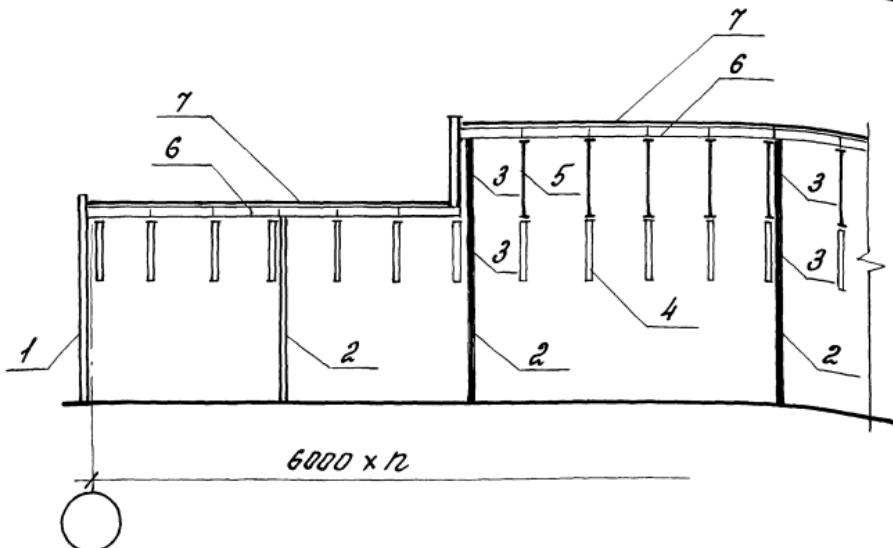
Пример расположения противопожарных перегородок в разрезе здания с отражающими конструкциями стен и покрытий из негорючих материалов
